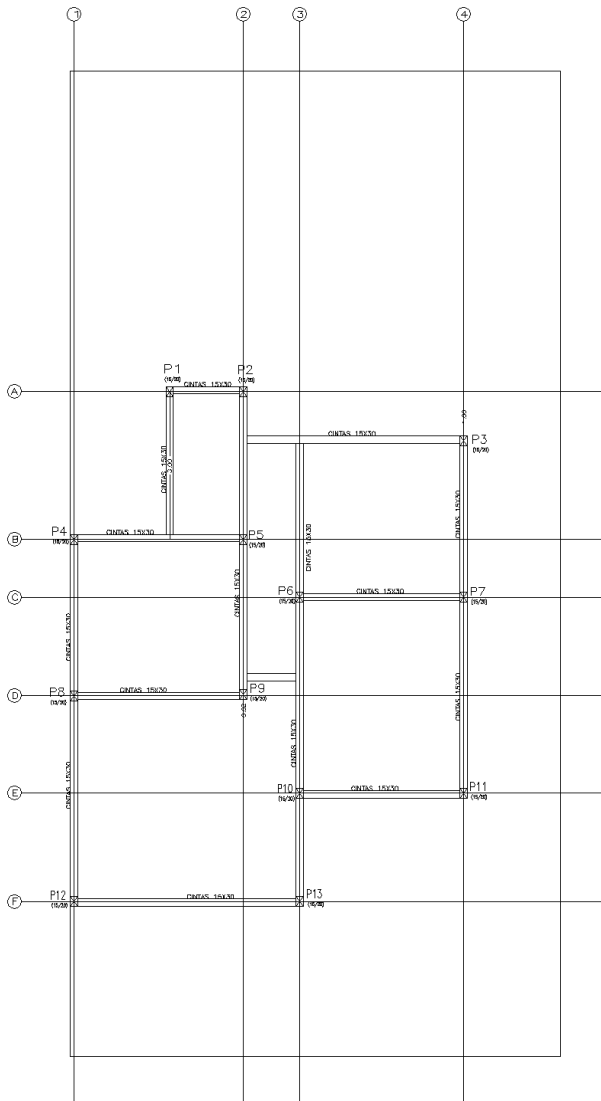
Detalhamento das sapatas, vigas baldrame e pilares
